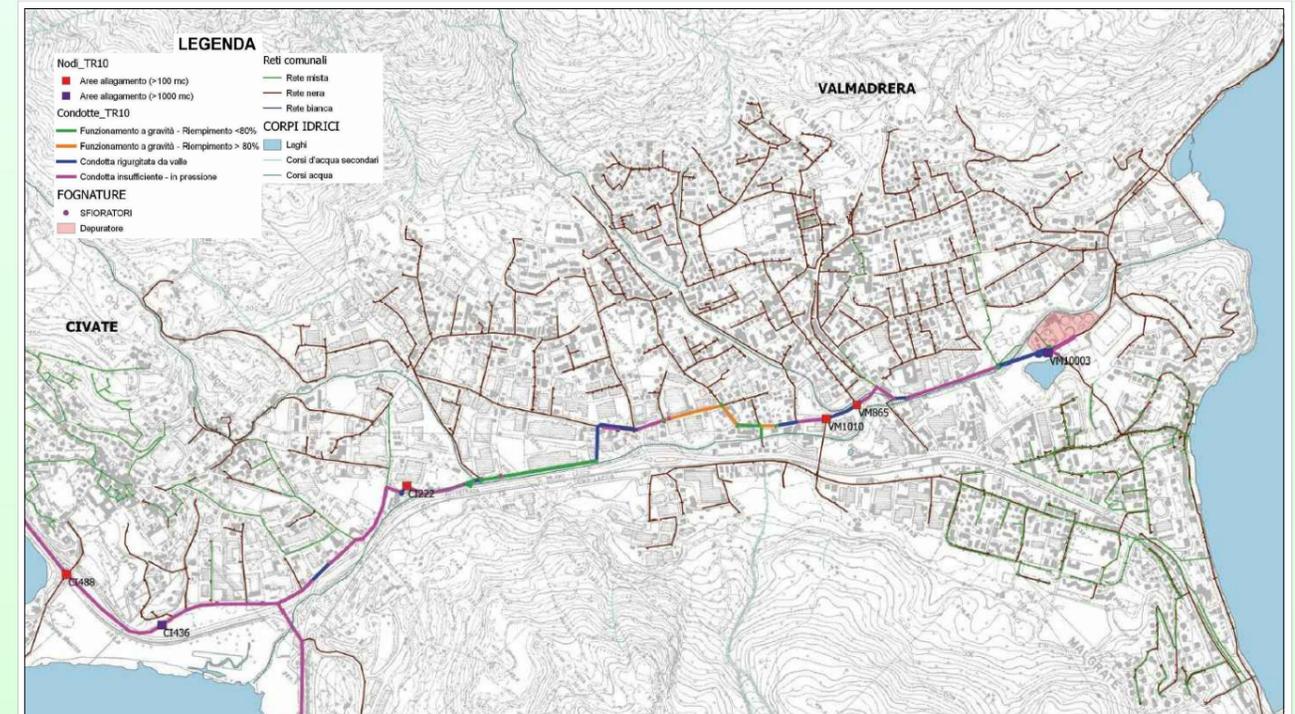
Stralcio planimetria simulazione funzionamento idraulico collettore
